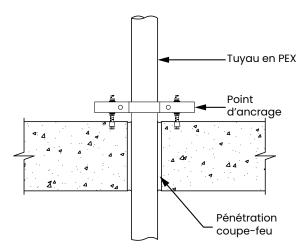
Example de point d'ancrage 1 (tuyauterie verticale)
